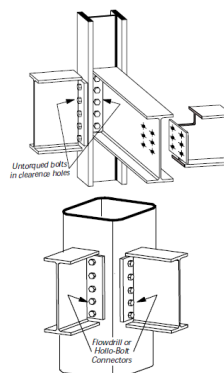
Ligação viga-pilar e viga-viga com placas de extremidade (SCI/BCSA, *Joints in steel construction - simple connections., 2006*)
